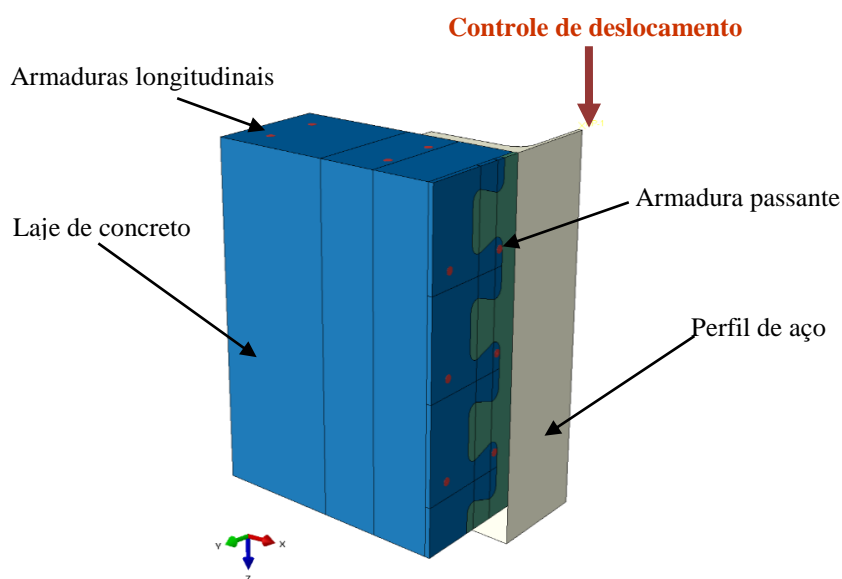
Lajes submetidas à cisalhamento com 3 *dowels* de concreto.
